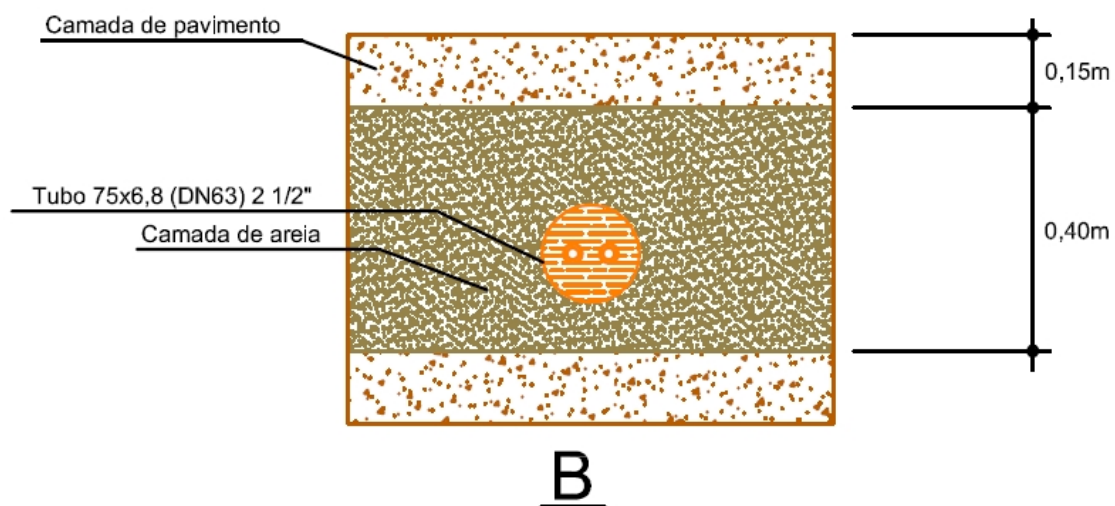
Representação da vala técnica da tubagem do tube de 63mm
